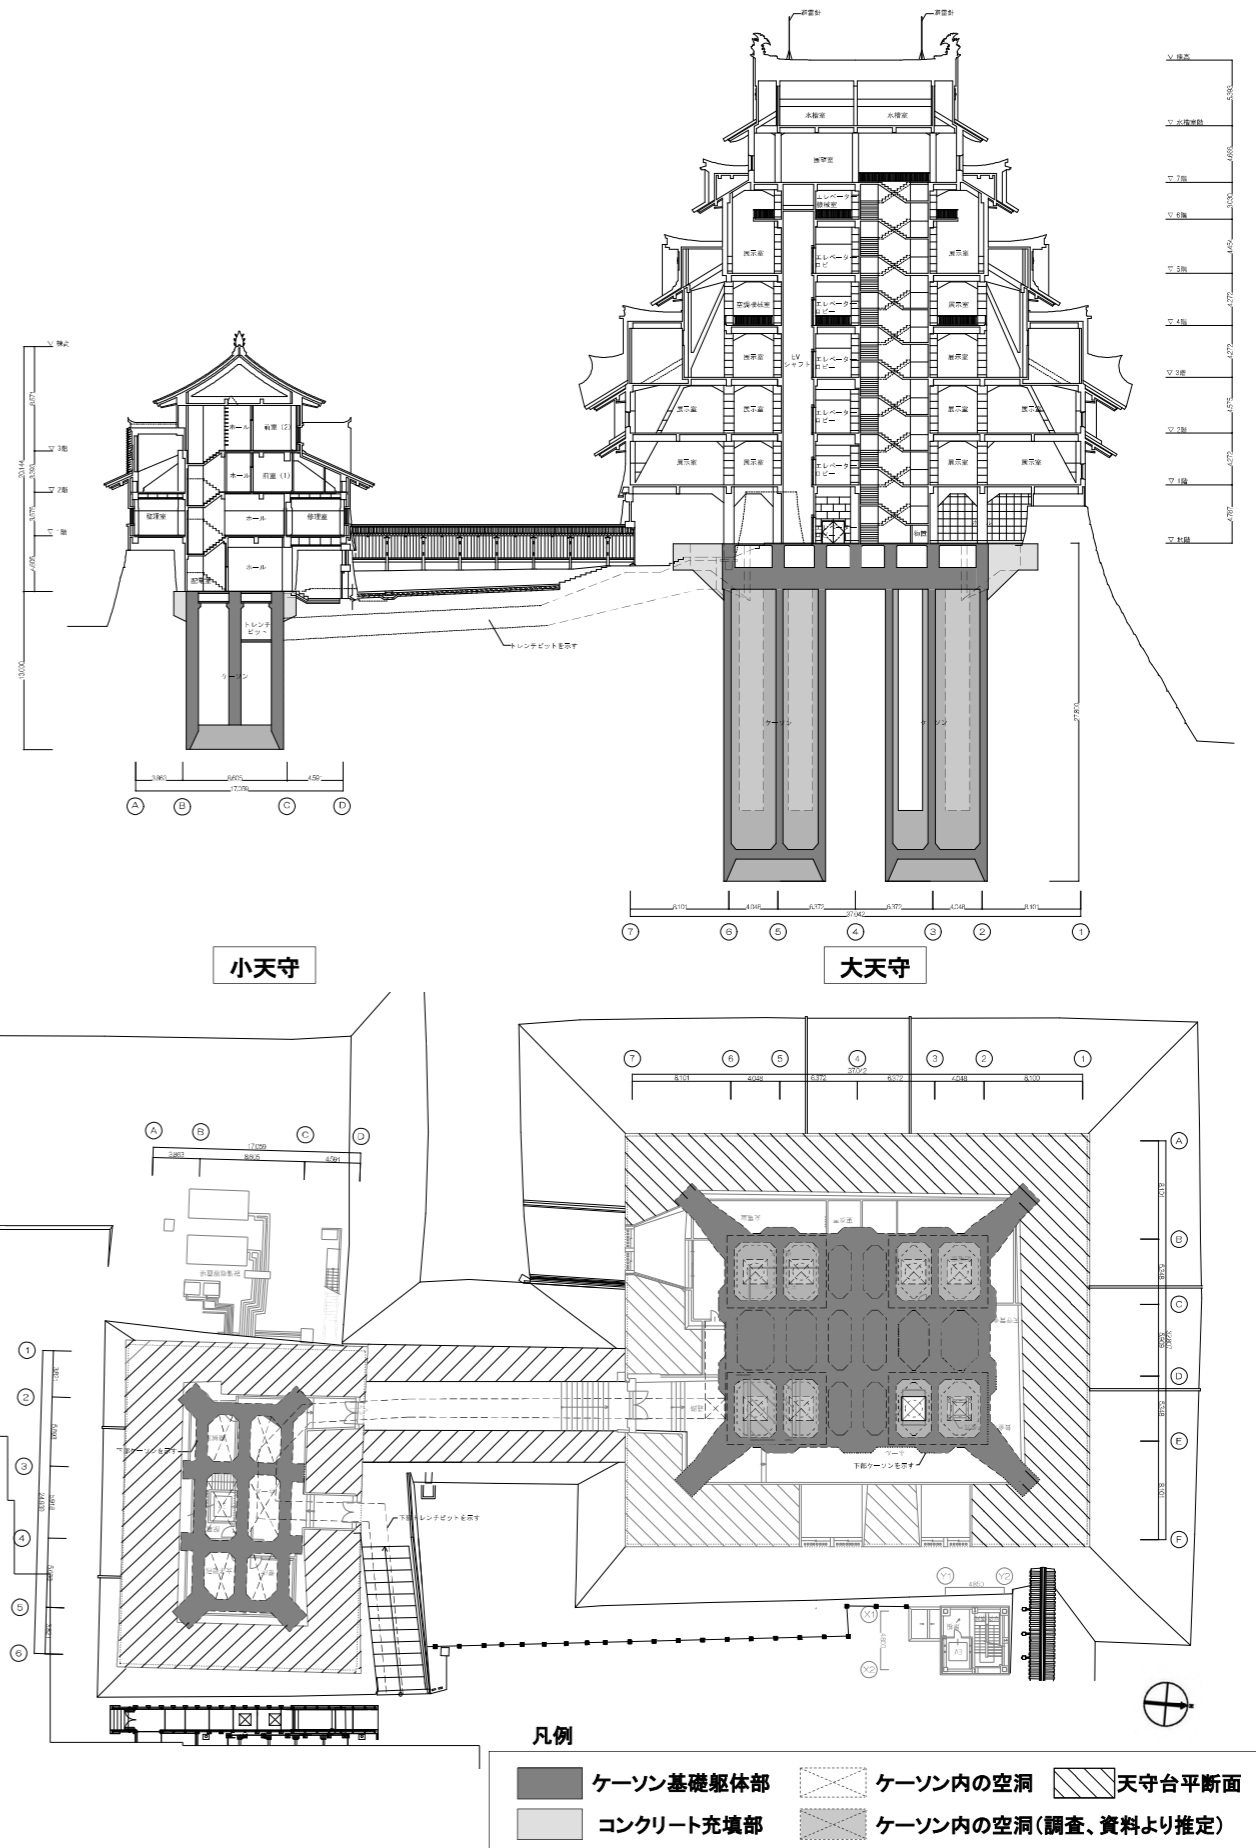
現天守閣ケーソン基礎平面図・断面図
